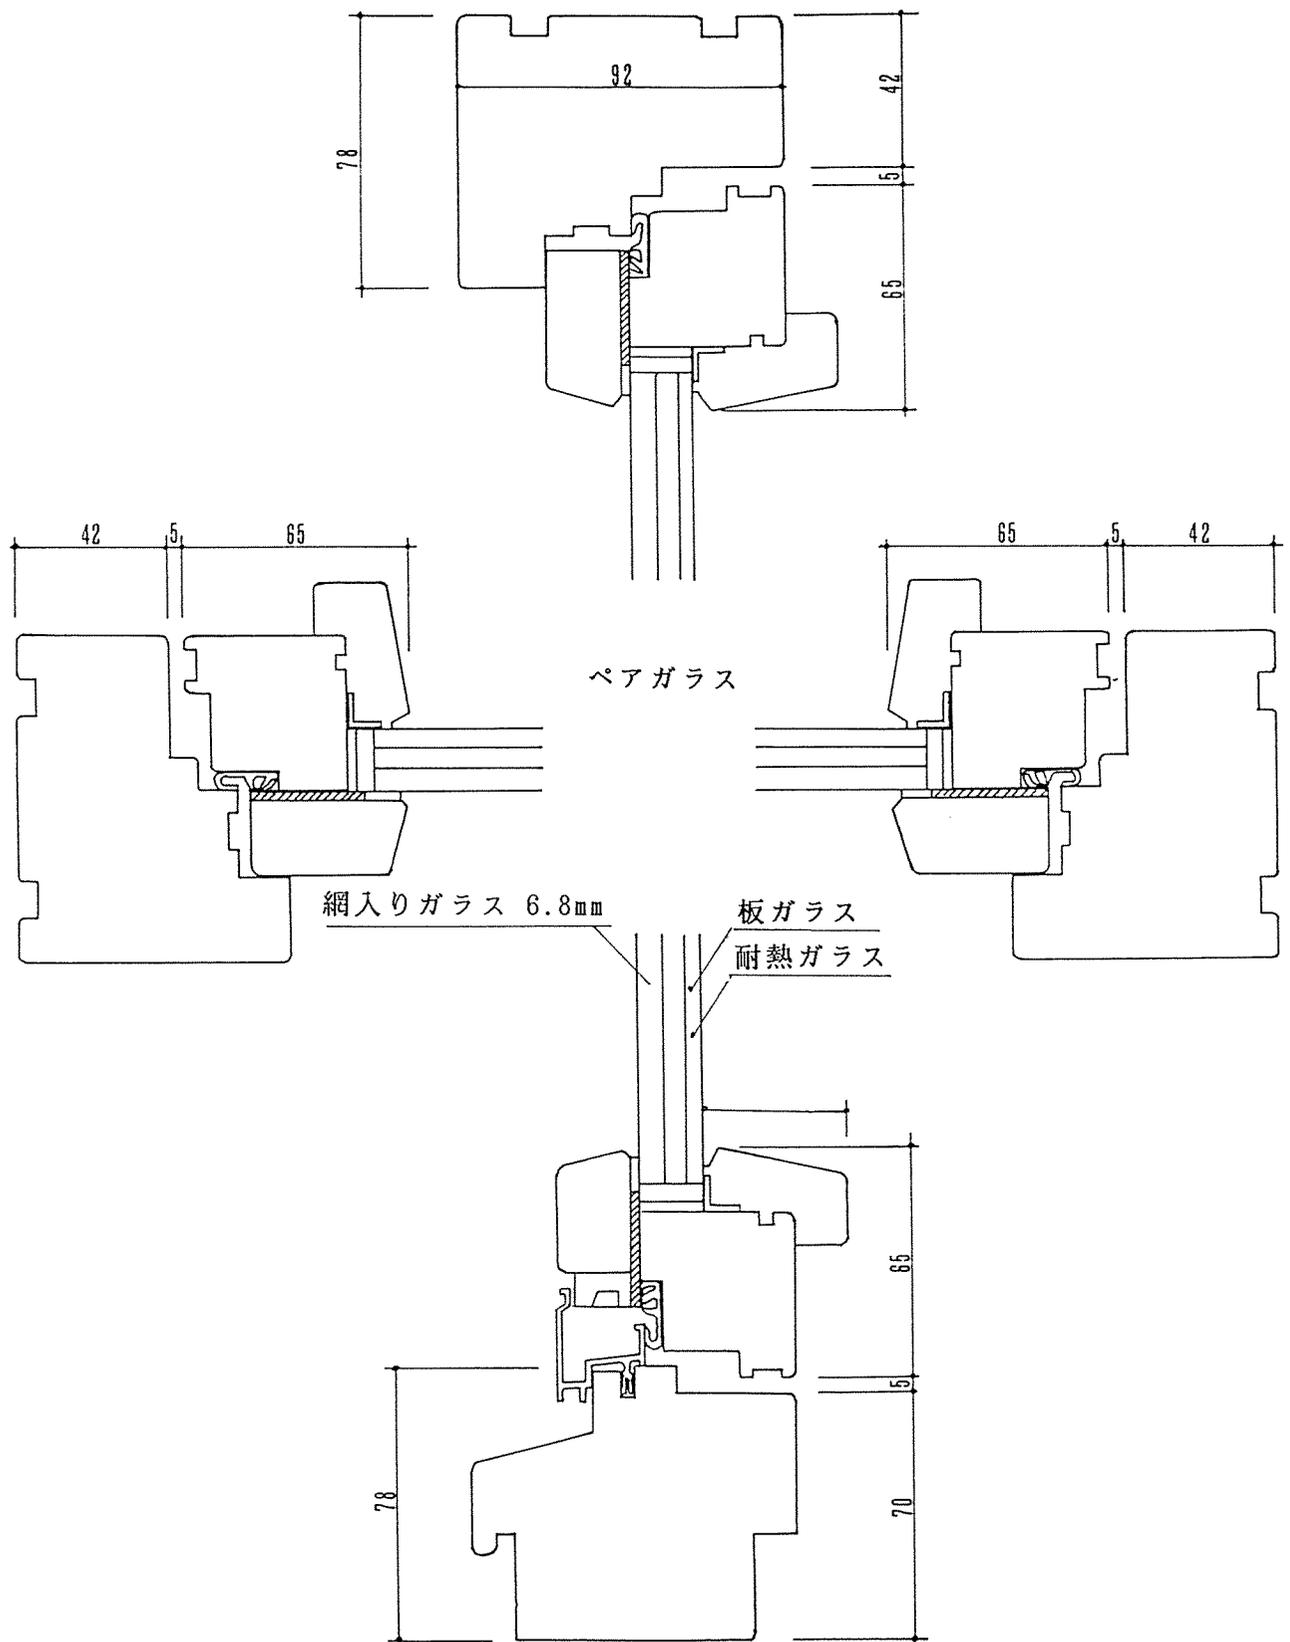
試験体記号 SD-21, -22, -23、断面詳細図
